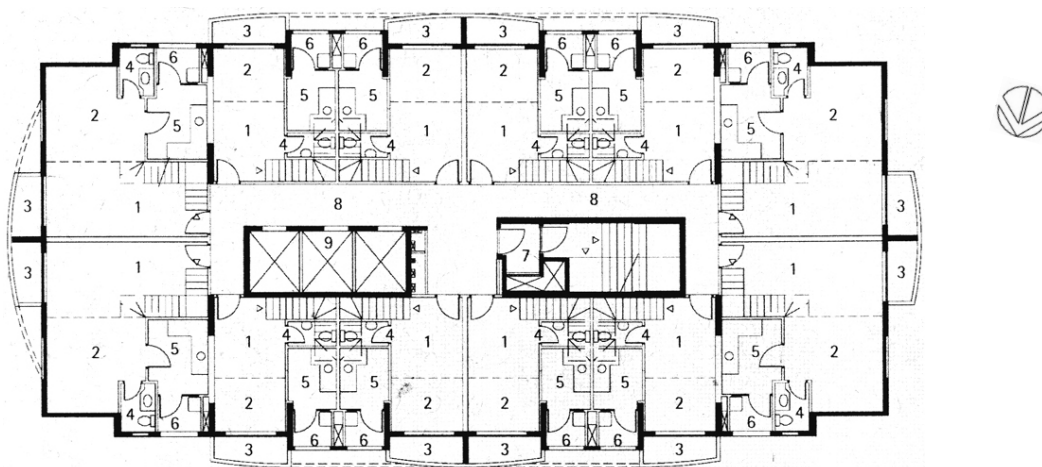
Planta tipo do Edifício Duplex Top Tower (VA-08).
